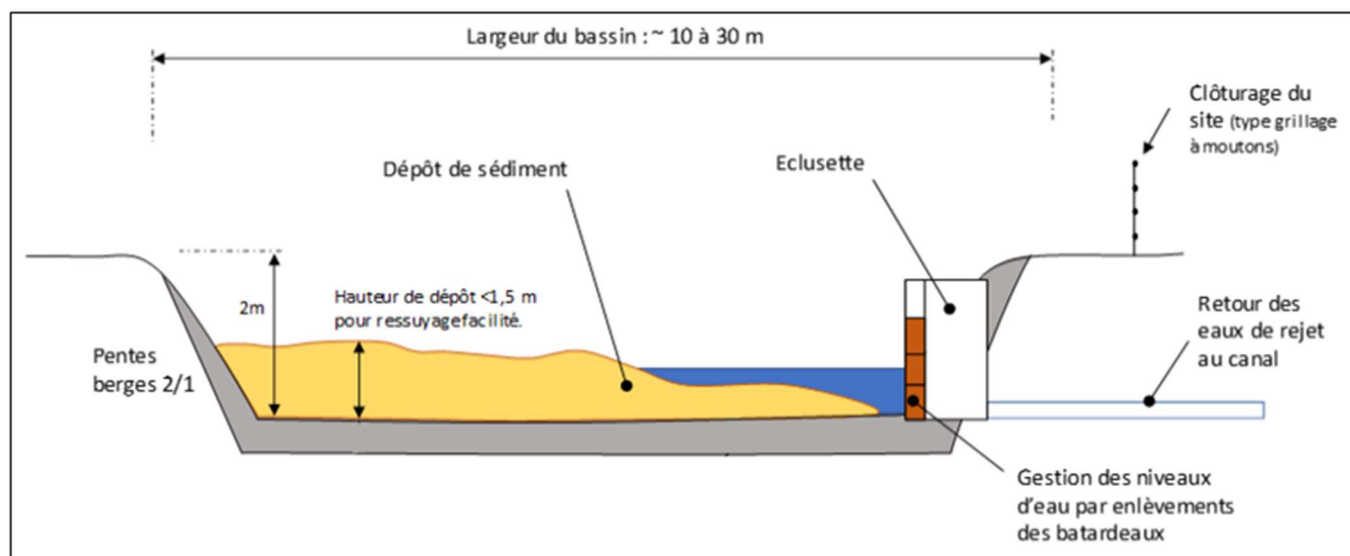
Coupe type d'un site de transit (source : IDRA)
